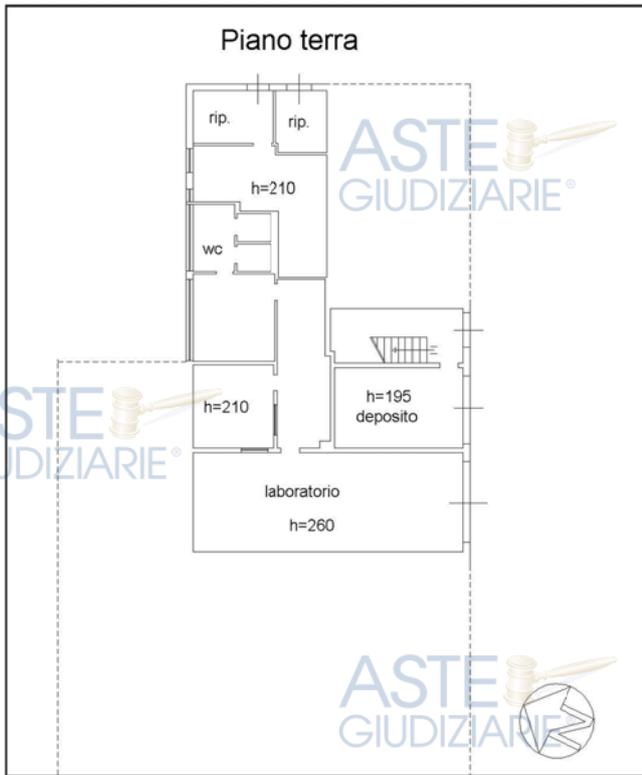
Lotto n° 01 - Stralcio della planimetria catastale.
